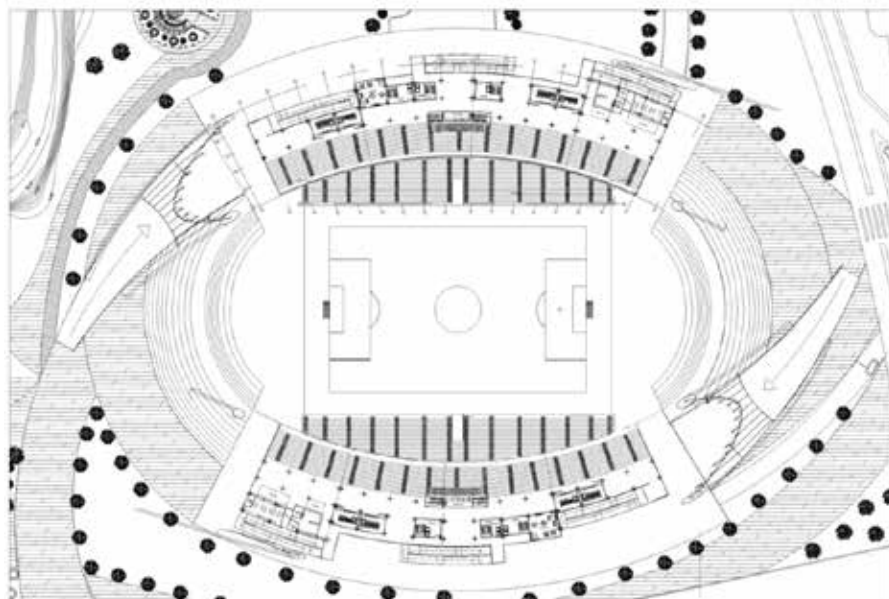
Planta Nivel +16.56, Planta de Prensa.
